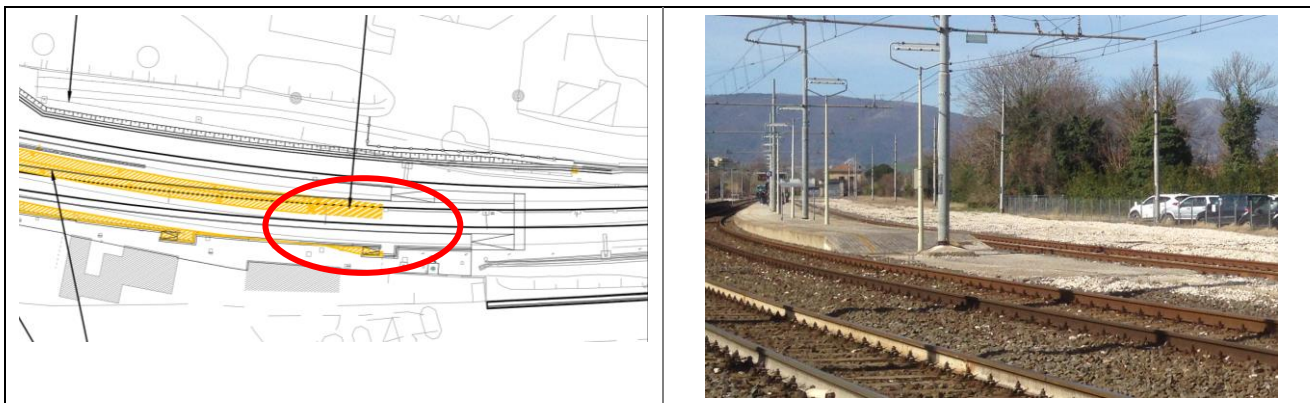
Rampa di accesso al marciapiede nord oggetto di demolizione
